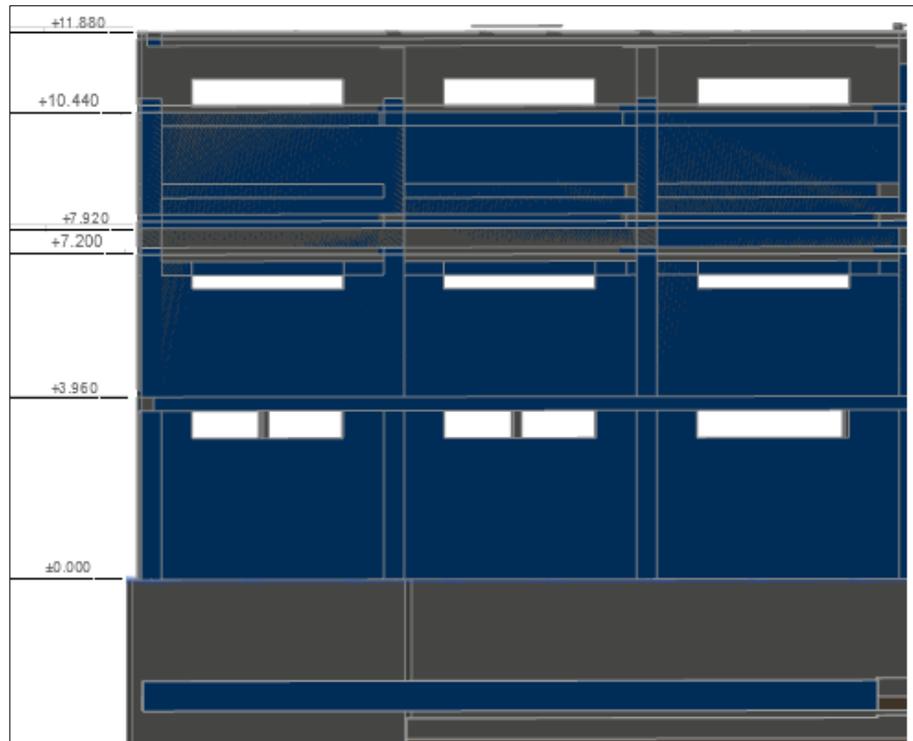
Muro en eje R, interacción de maqueta final e inicial.
